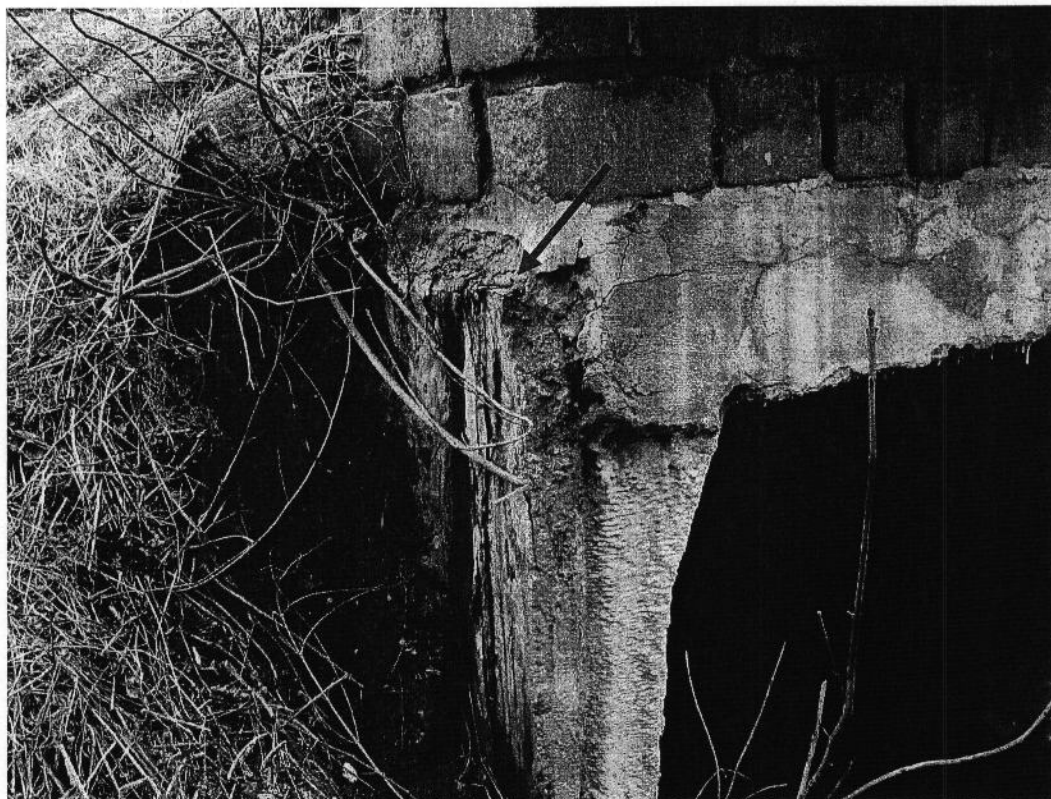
detail čela mostní konstrukce. Dochází zde až k extrémní (typ E) degradaci povrchu betonu a korozi výztuže. Na povrchu betonu dochází lokálně k vyluhování vápenných složek. V těchto místech dochází i k odhalení hydroizolace a její degradaci.
